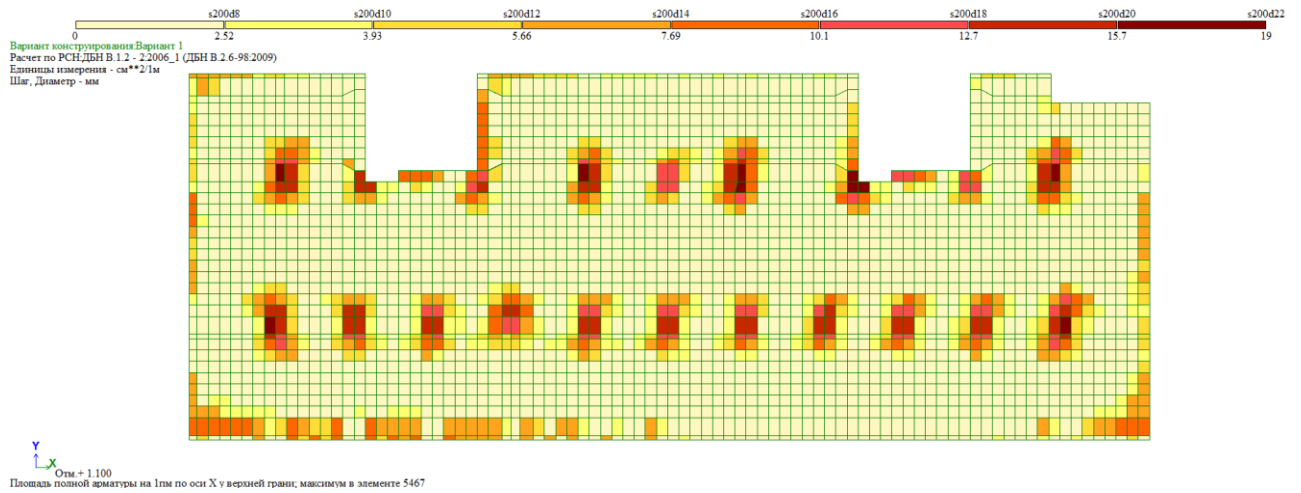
Розрахункове армування верхньої грані плити перекриття на відм. +1,100 вздовж осі X від основних сполучень навантажень
